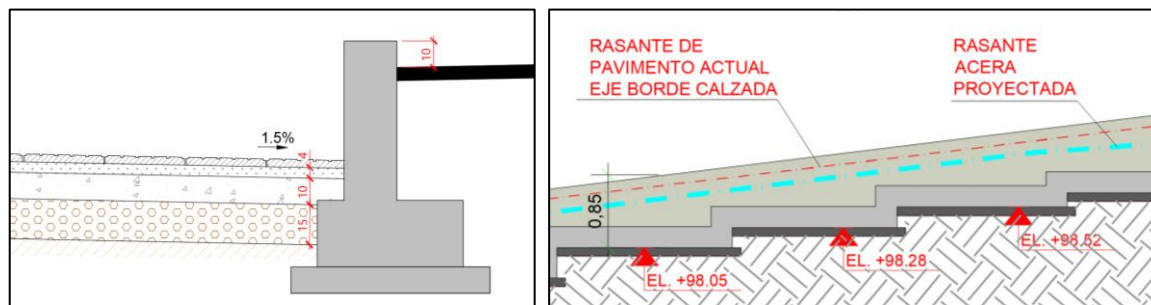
Vista longitudinal y transversal del muro proyectado
